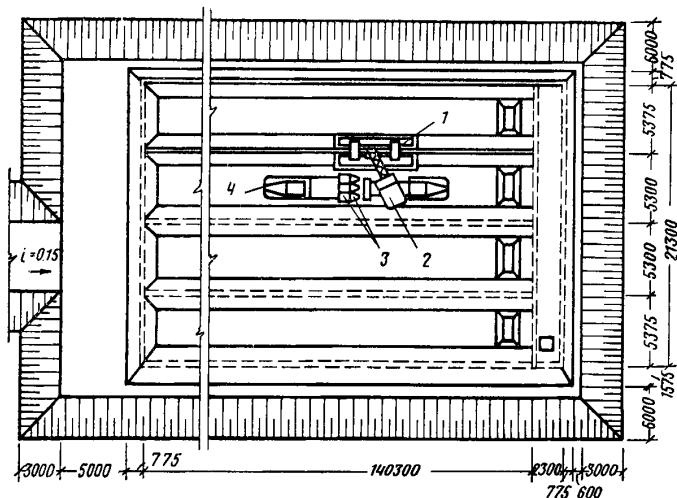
Бетонирование стен отстойника с помощью горизонтально-скользящей опалубки
